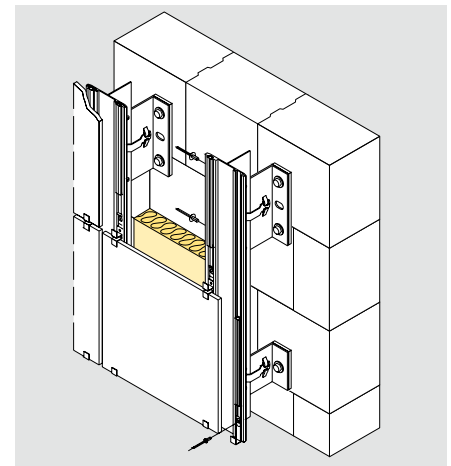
Aluminium-Unterkonstruktion mit Wandhaltern
